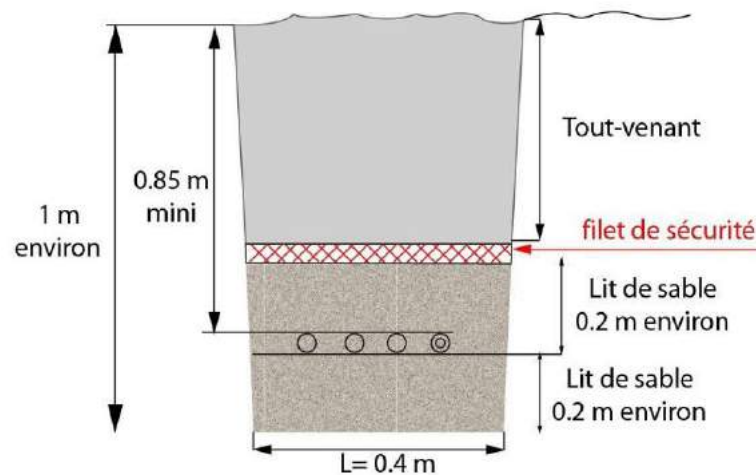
Coupe de tranchée pour enfouissement de ligne
